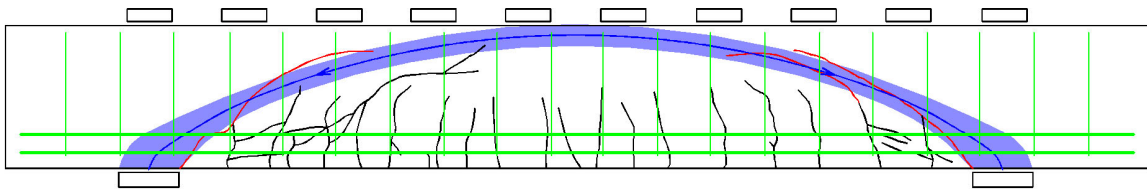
Balken B 2 mit überlagerter Druckparabel und zugehörigen Rissen
